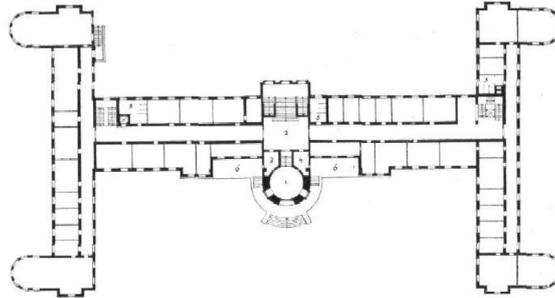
Clemens Holzmeister, Generalstabsgebäude Ankara, Grundriss.
